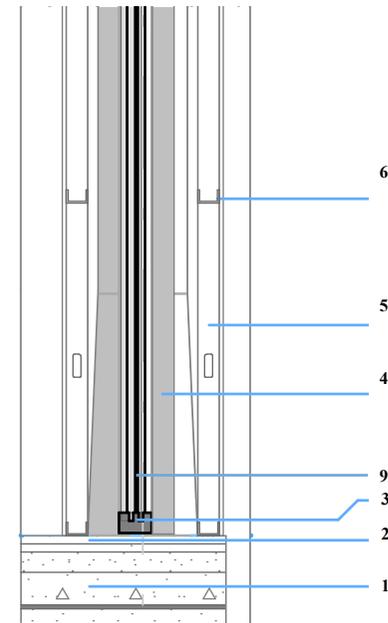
Detalle constructivo sección 2 parte 2. Fuente: Autora.
